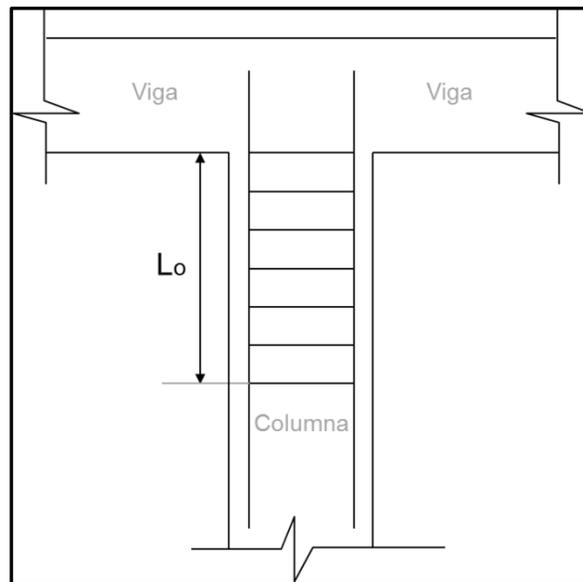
Longitud L_o de colocación de acero transversal en columnas. Fuente: Autor
